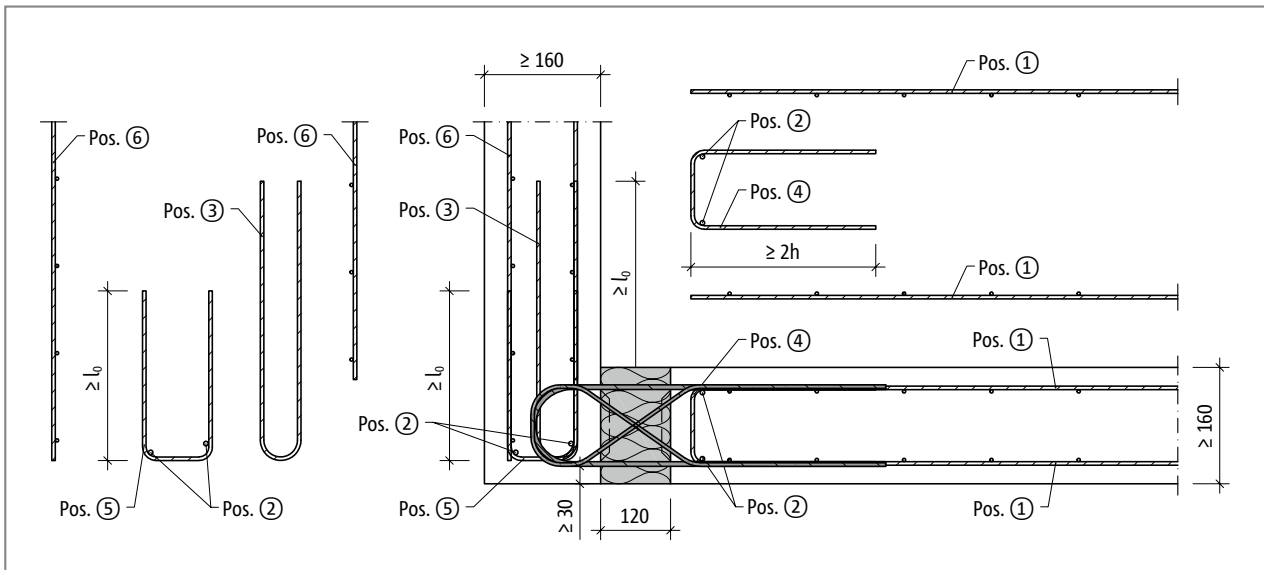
Schöck Isokorb® XT Typ AP horizontale Anordnung: Bauseitige Armierung
